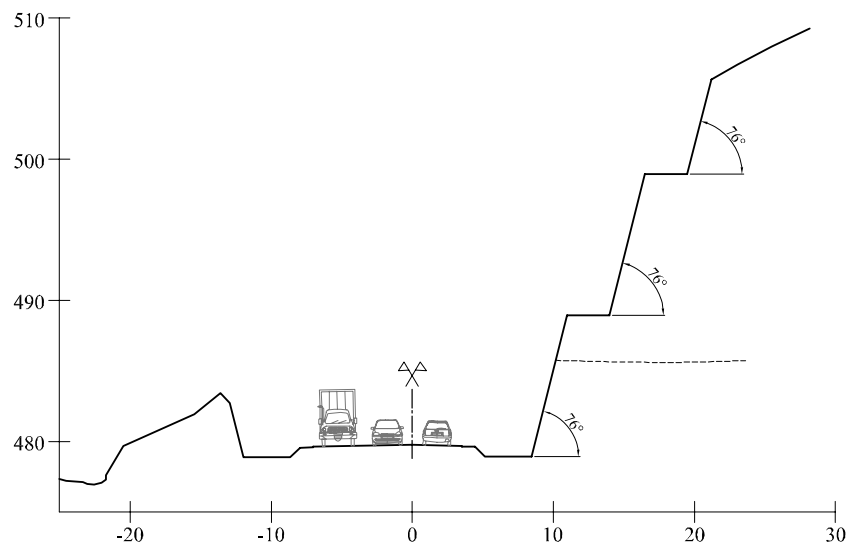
Geometria da seção transversal no 55+360 – planalto.
